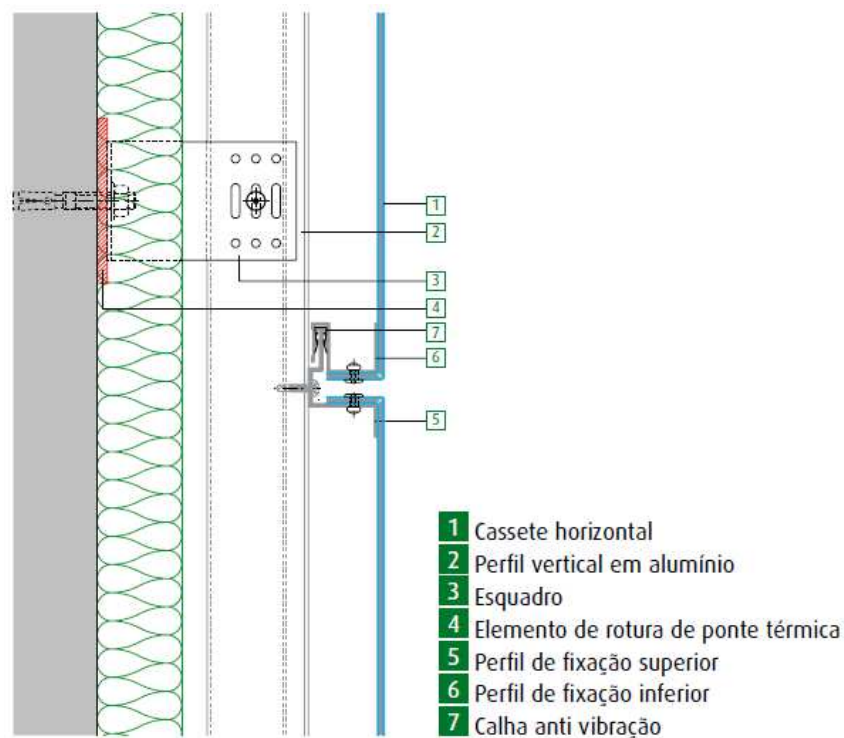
Pormenor construtivo do sistema de cassetes horizontais [6]
